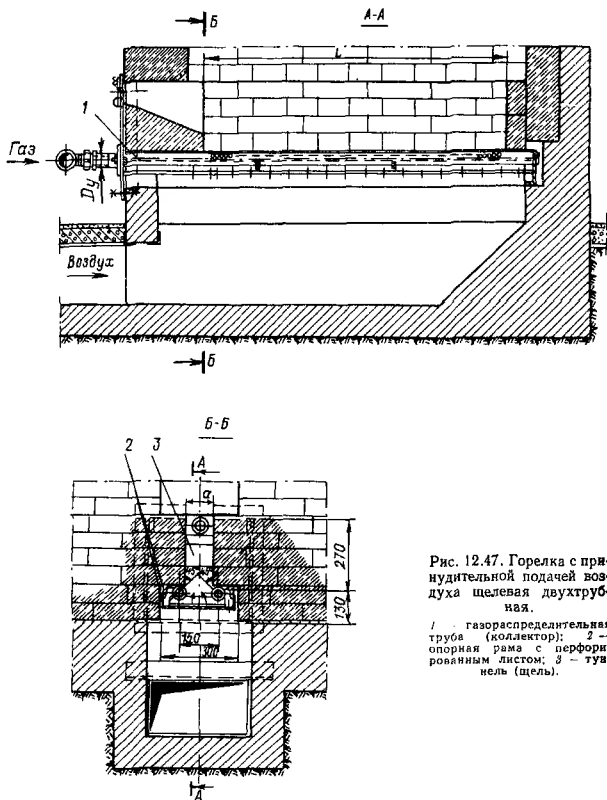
Горелка с принудительной подачей воздуха щелевая двухтрубная.
